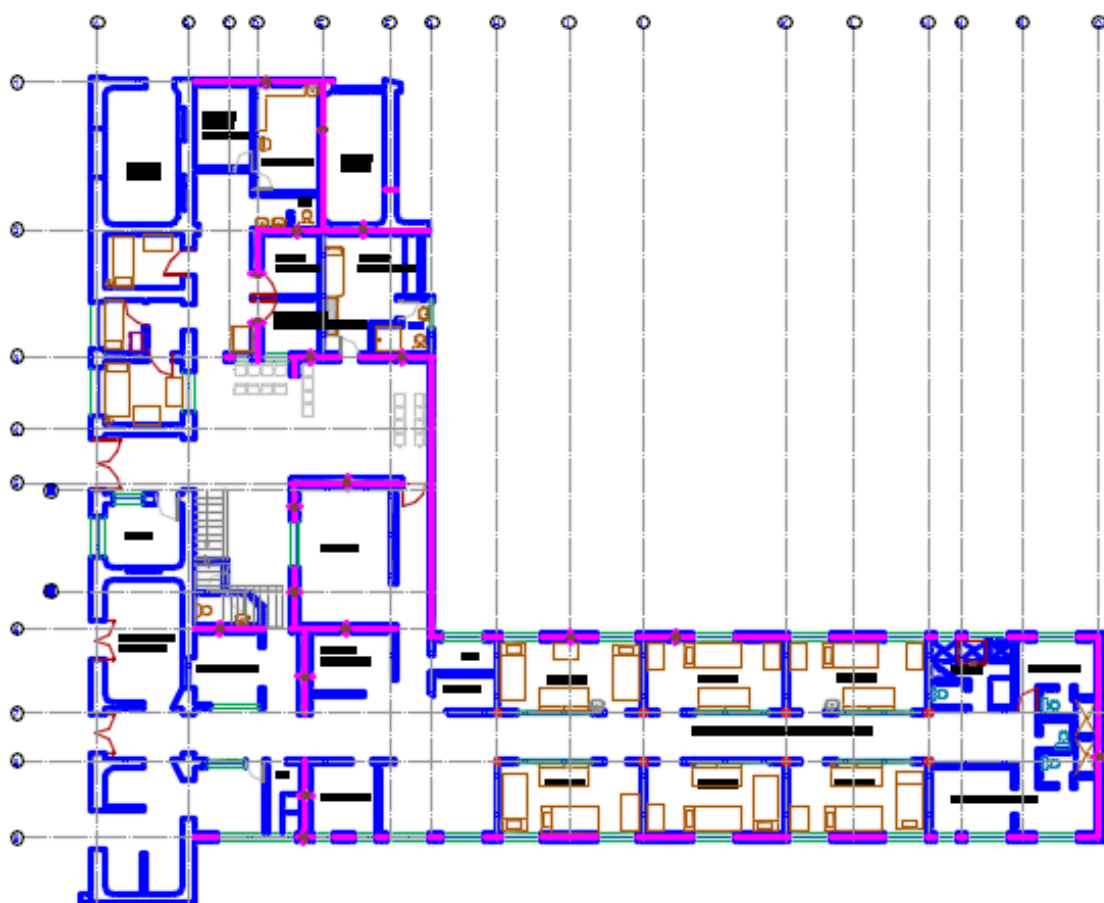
Plano utilizado para modelo ETABS. Fuente: Autor
